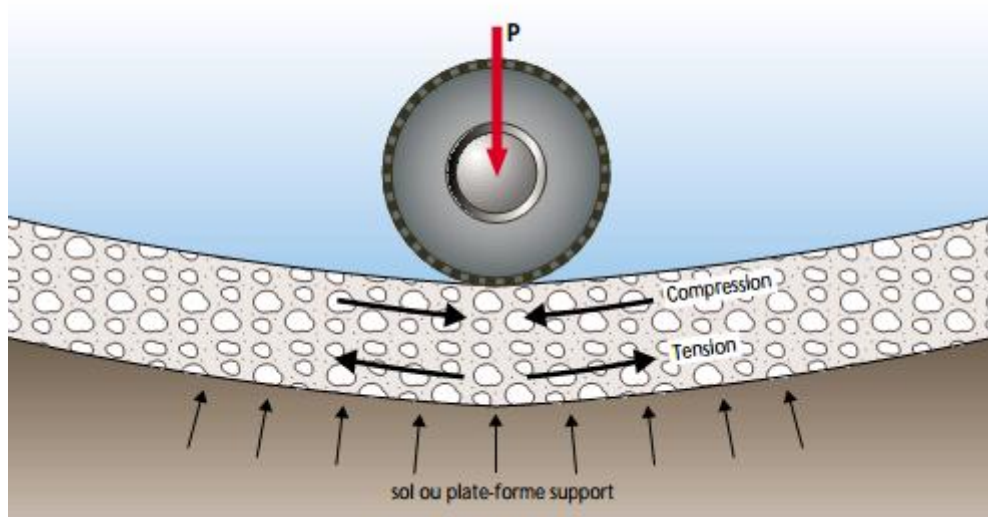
Schéma de fonctionnement d'une chaussée constituée d'une couche traitée au ciment reposant sur le sol naturel
